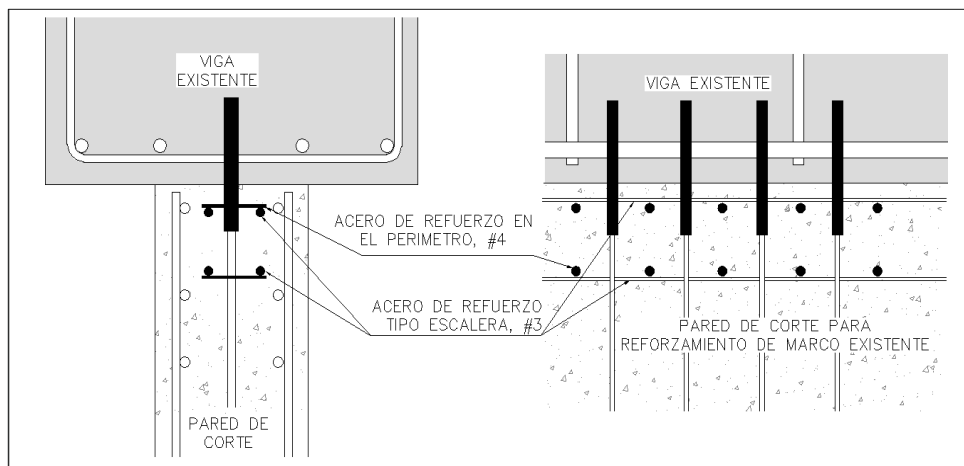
Refuerzo contra el agrietamiento con barras de refuerzo tipo escalera
